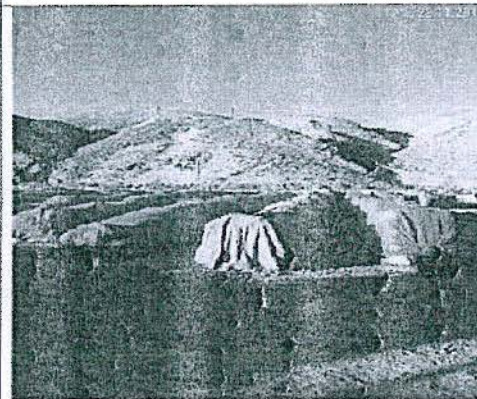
Cajas de logueo cubiertas con Geomanta
